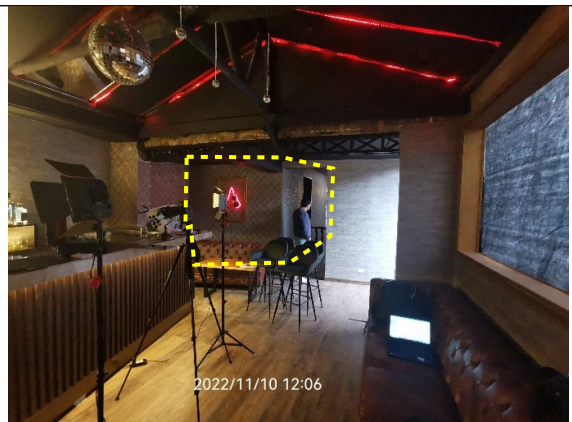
Reforzamiento de la escalera con estructura metálica
